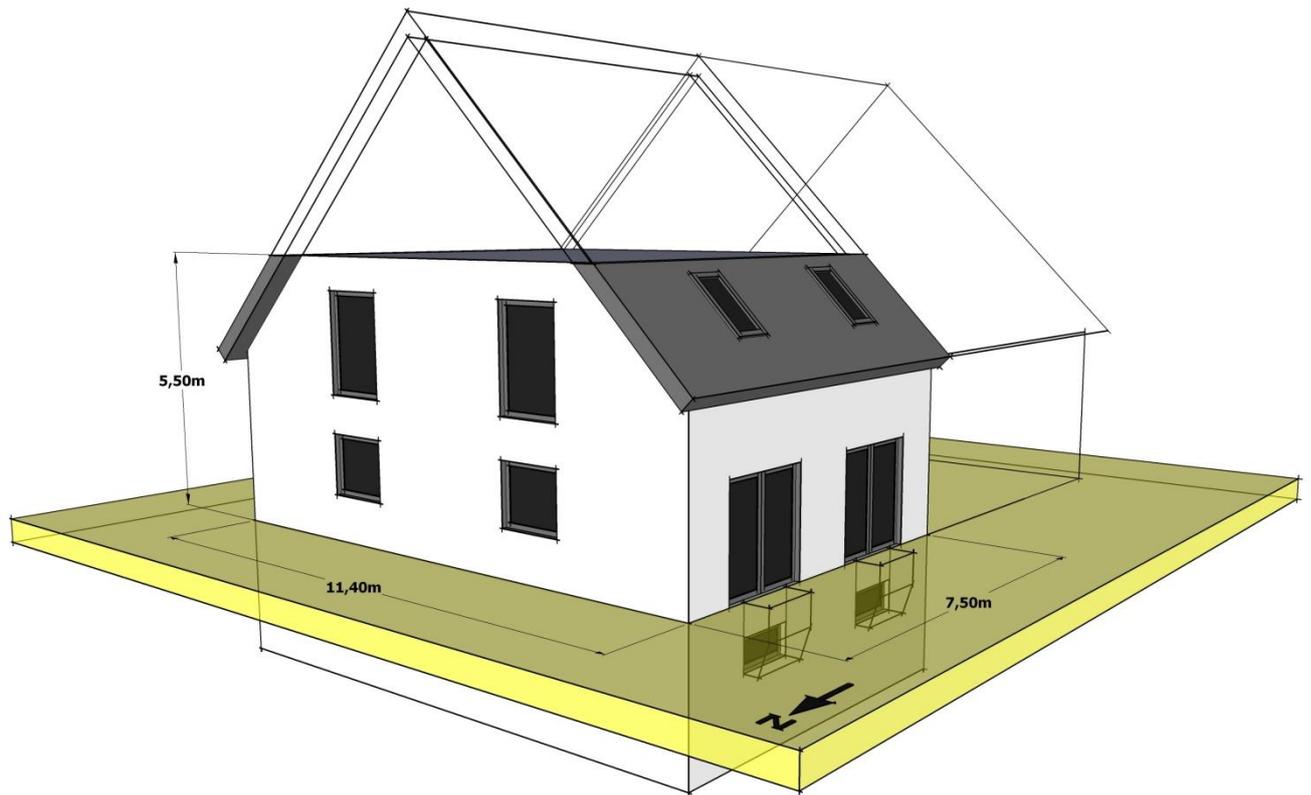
Doppelhaushälfte Nord mit Keller- Ansicht Nord-West
